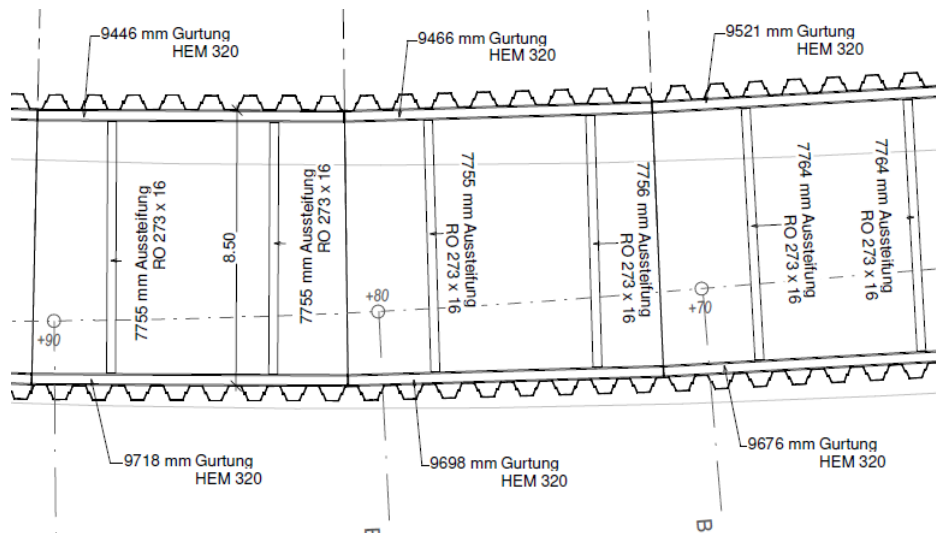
Grundrissausschnitt Regelbereich Hauptbaugrube, 1. Steifenlage
